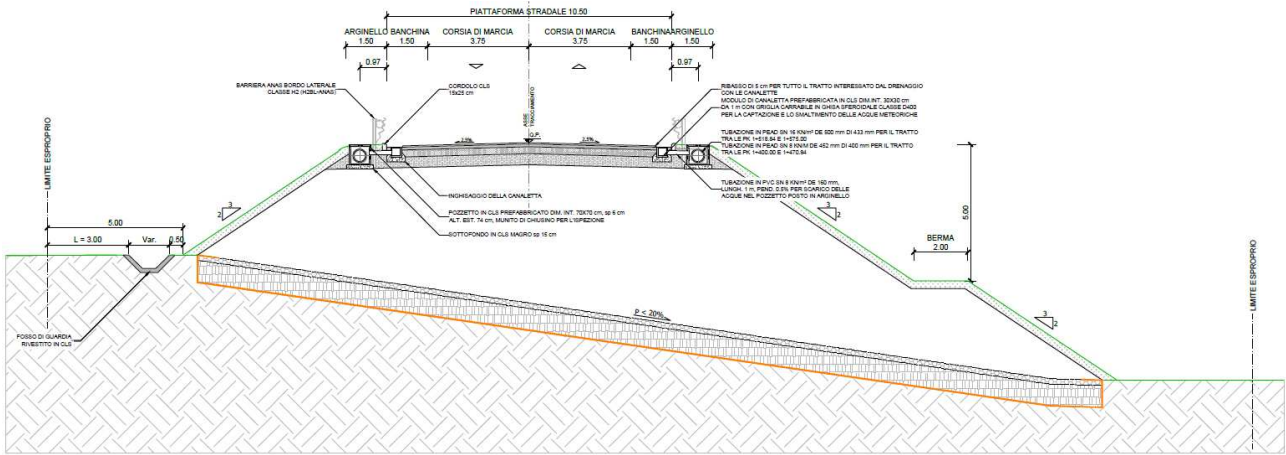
Sezione tipo in rilevato tra le pk 1+400 e 1+575
